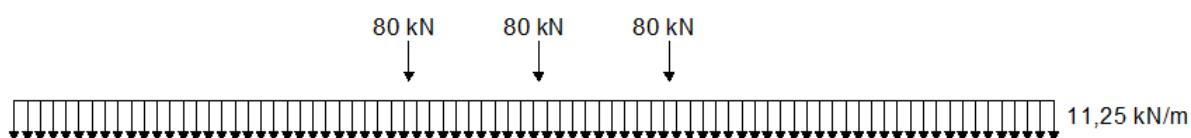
Reações de apoio para a primeira situação de carregamento.
